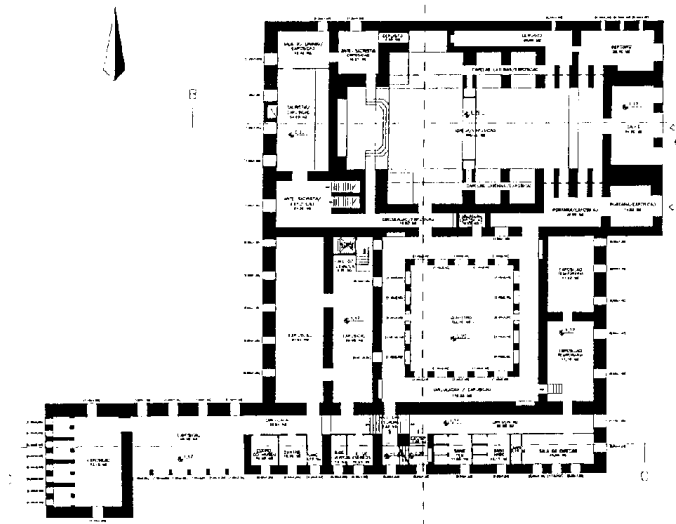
Planta baixa do primeiro pavimento do Museu de Arte Sacra da UFBA
